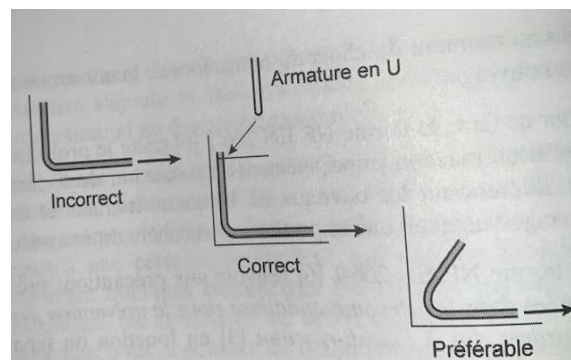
Poussée au vide par ancrage des barres en retour rectiligne parallèle au parement [13].
